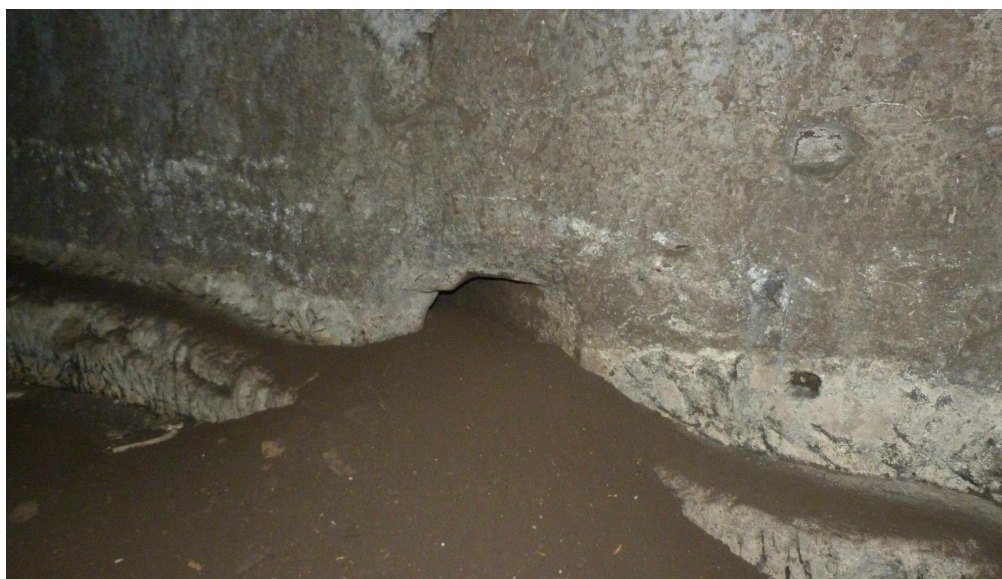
Un piccolo condotto al piede della galleria, con fuoriuscita di materiale terroso
